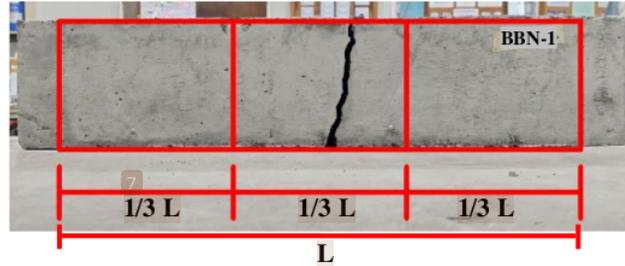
Pola Keruntuhan Lentur Balok Beton
